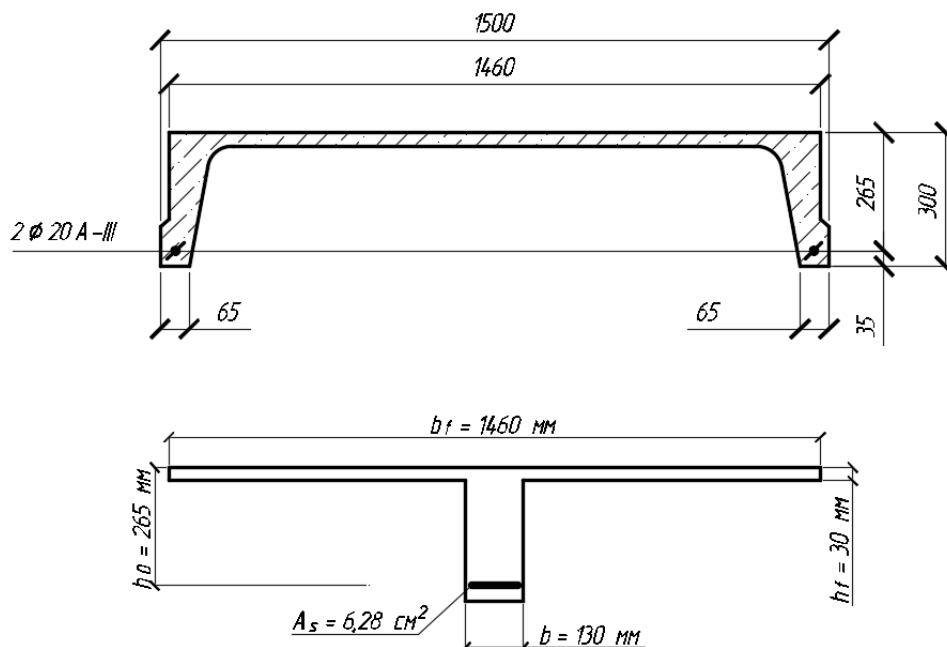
Поперечное сечение ребристой плиты покрытия.
